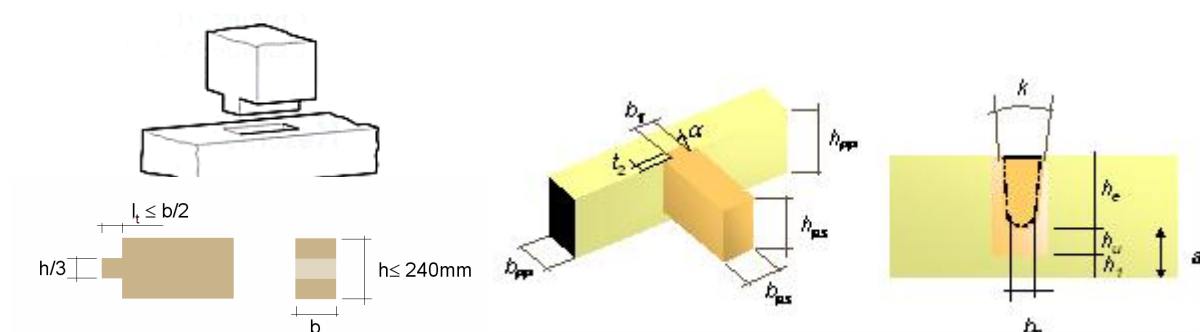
Assemblage par tenon ou queue d'aronde
